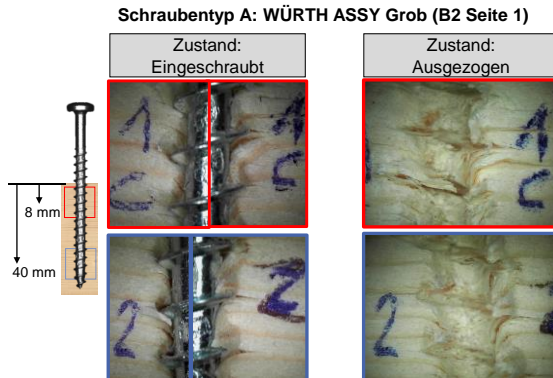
Gewindekontakt des Schraubentyps A der Analysetechnik *Sectional Imaging*.
